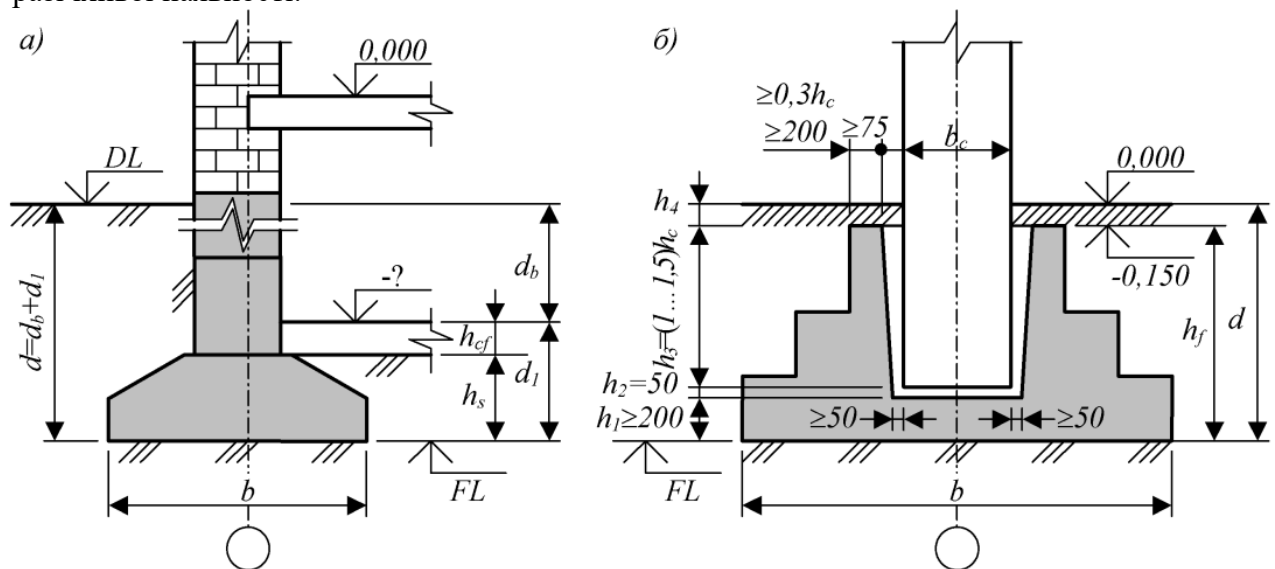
Схема до визначення глибини закладання фундаментів мілкого закладання залежно від конструктивних особливостей: *a* – для стрічкового фундаменту під стіну будівлі з підвалом; *б* – для стовпчастого фундаменту під збірну залізобетонну колону будівлі без підвалу; *DL* – відмітка поверхні спланованого рельєфу; *FL* – відмітка підшови фундаменту; b_c і h_c – розміри поперечного перерізу колони
